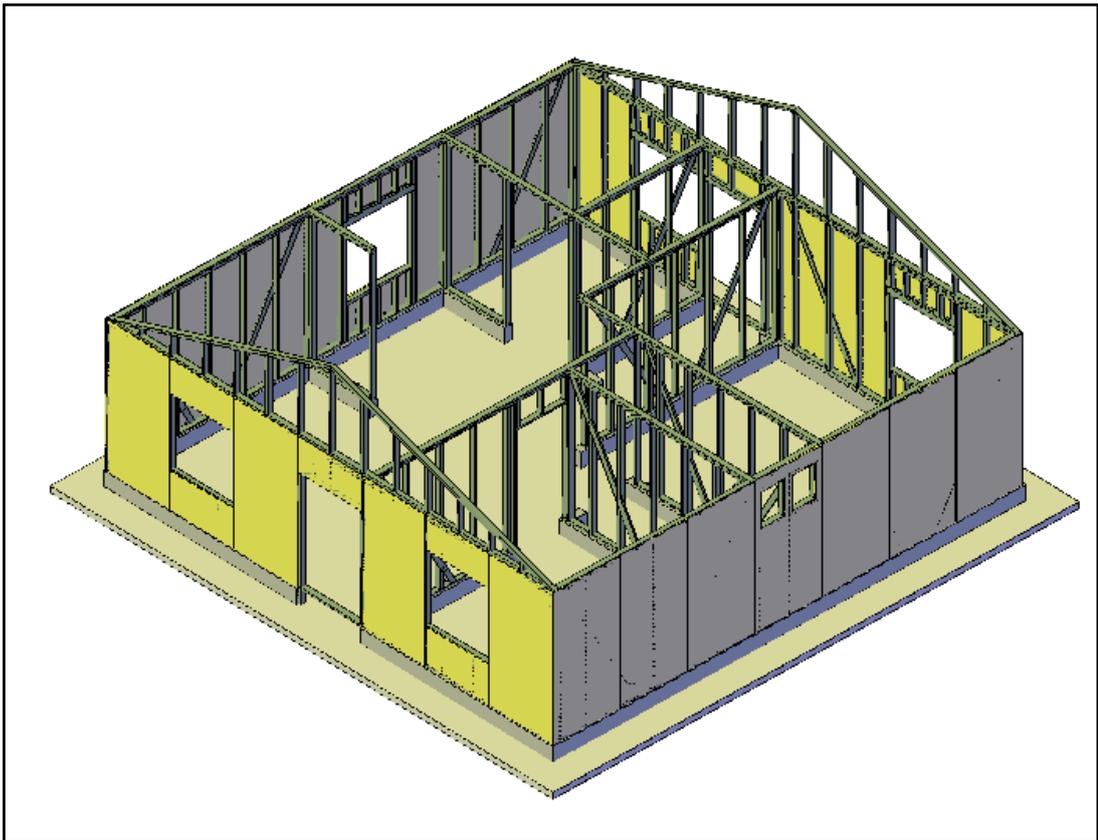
Colocación de tableros contrachapados de 12 mm para exteriores (FF) en los muros perimetrales.
